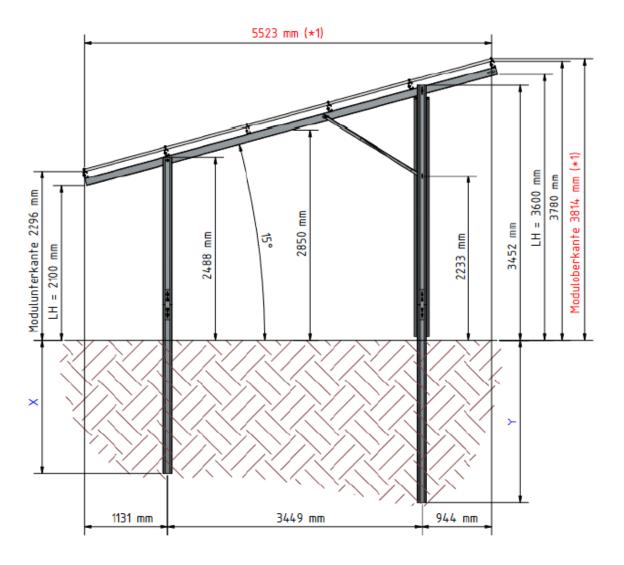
Modulquerschnitt (SUNfarming GmbH)
